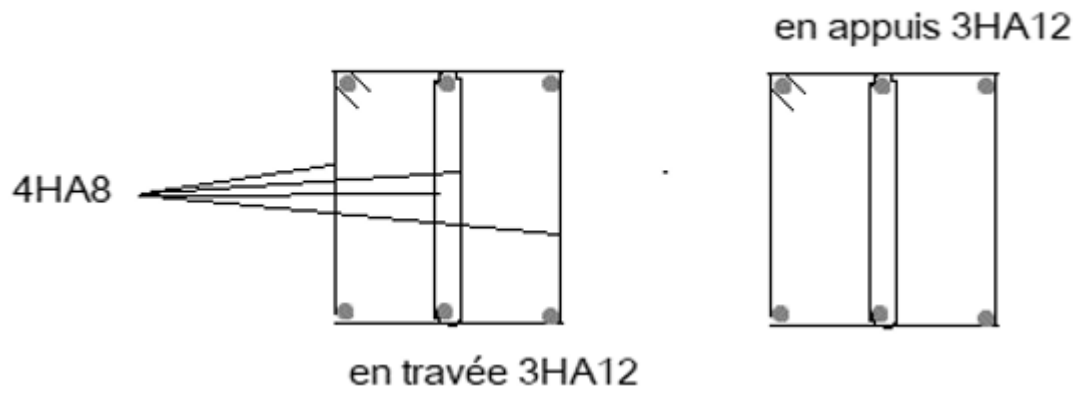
Plan de ferrailage de la poutre de chaînage
